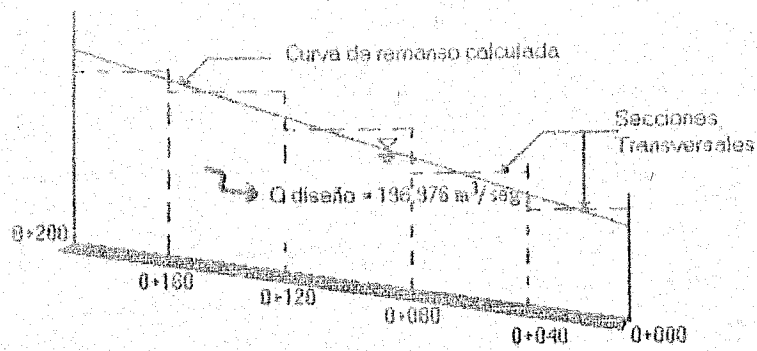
Corte longitudinal del arroyo Atolanga, para el cálculo del perfil hidráulico.
